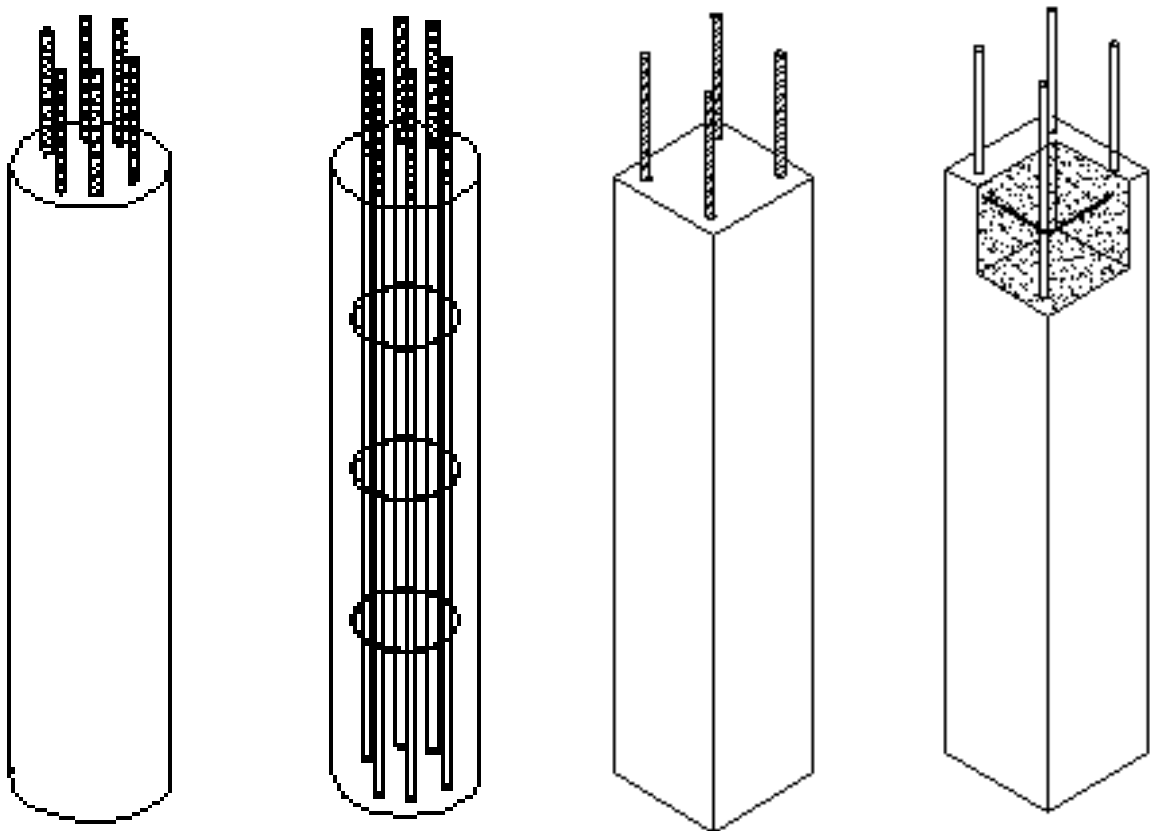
Disposición de las armaduras en las columnas de base cilíndrica y cuadrada.
